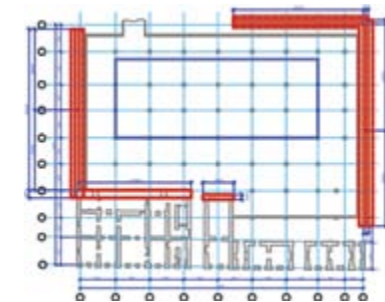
План закрепления грунтов паркинг-сейфа, усиления фундаментов и грунтов основания межевых стен сохраняемых зданий
